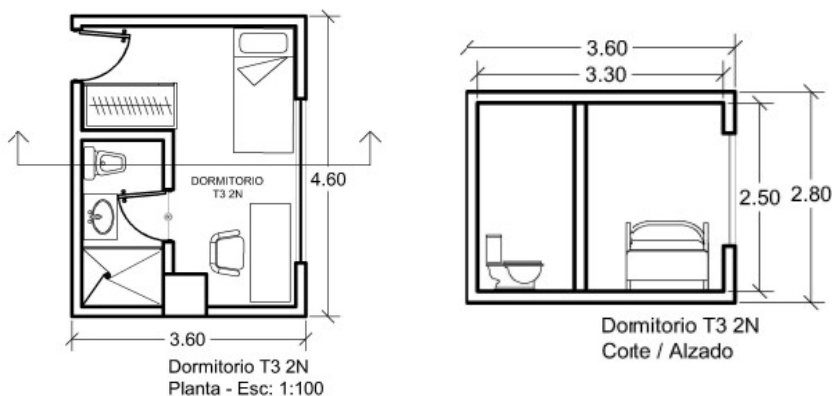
Planta y alzado de dormitorio individual con baño completo esc. 1:100
